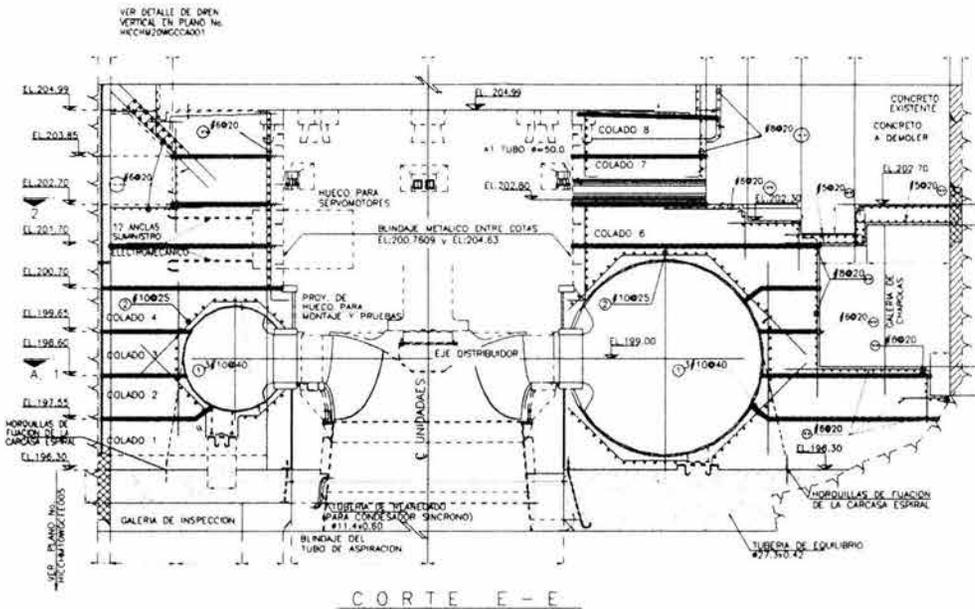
b Juntas constructivas (Corte E-E).
